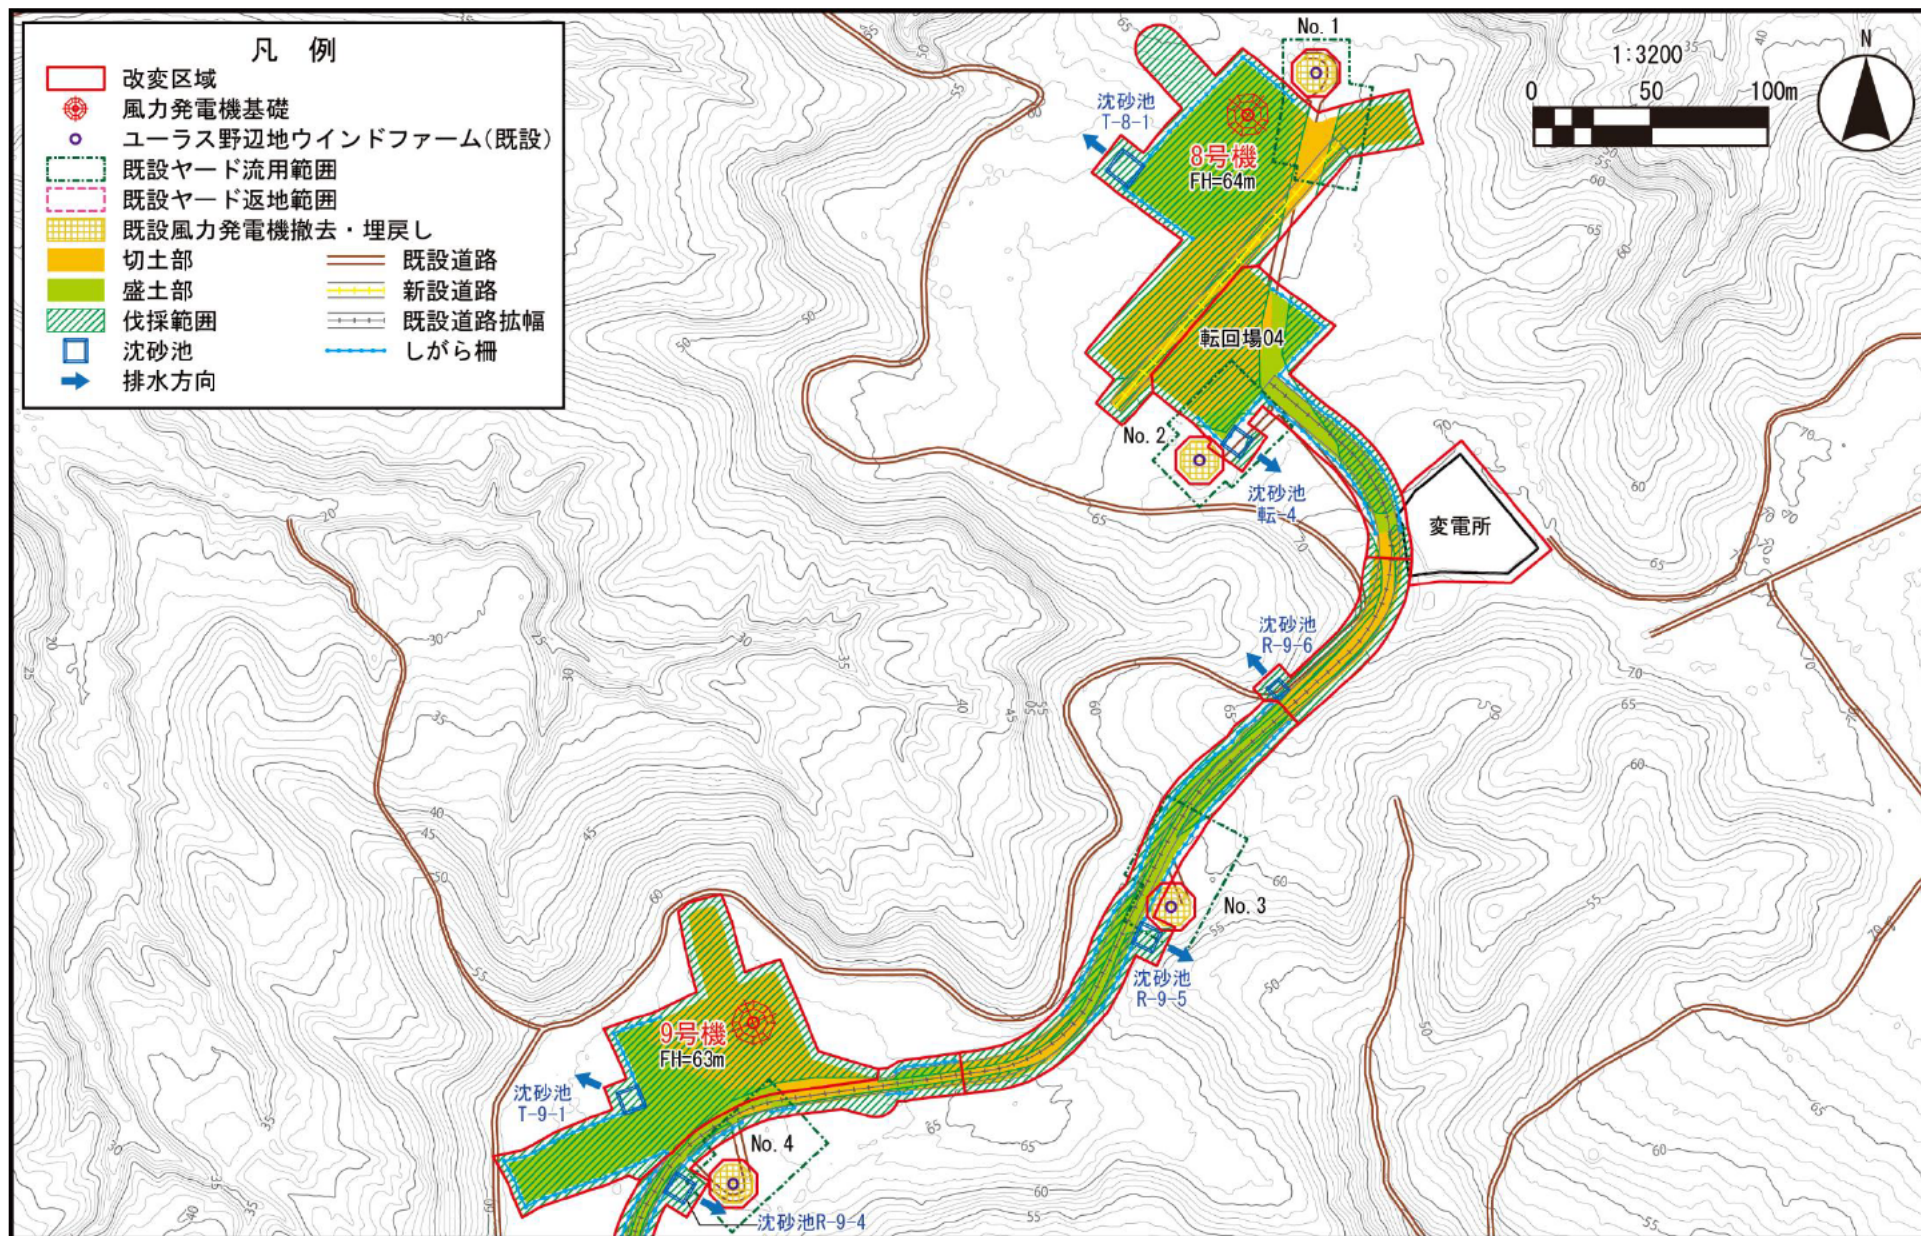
(9) 造成・基礎工事等に伴う変更区域図 (平面図)
